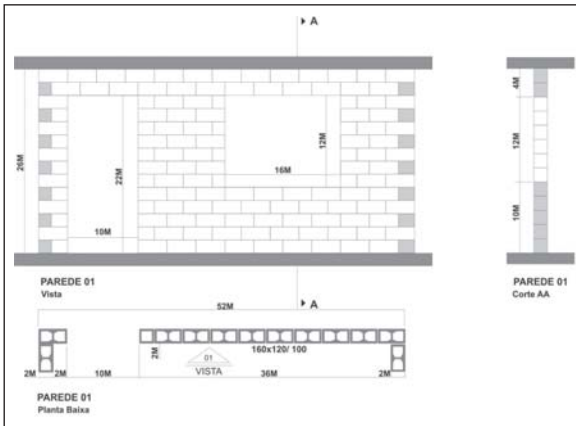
Planta e elevação de alvenaria projetada de acordo com os conceitos de coordenação modular
